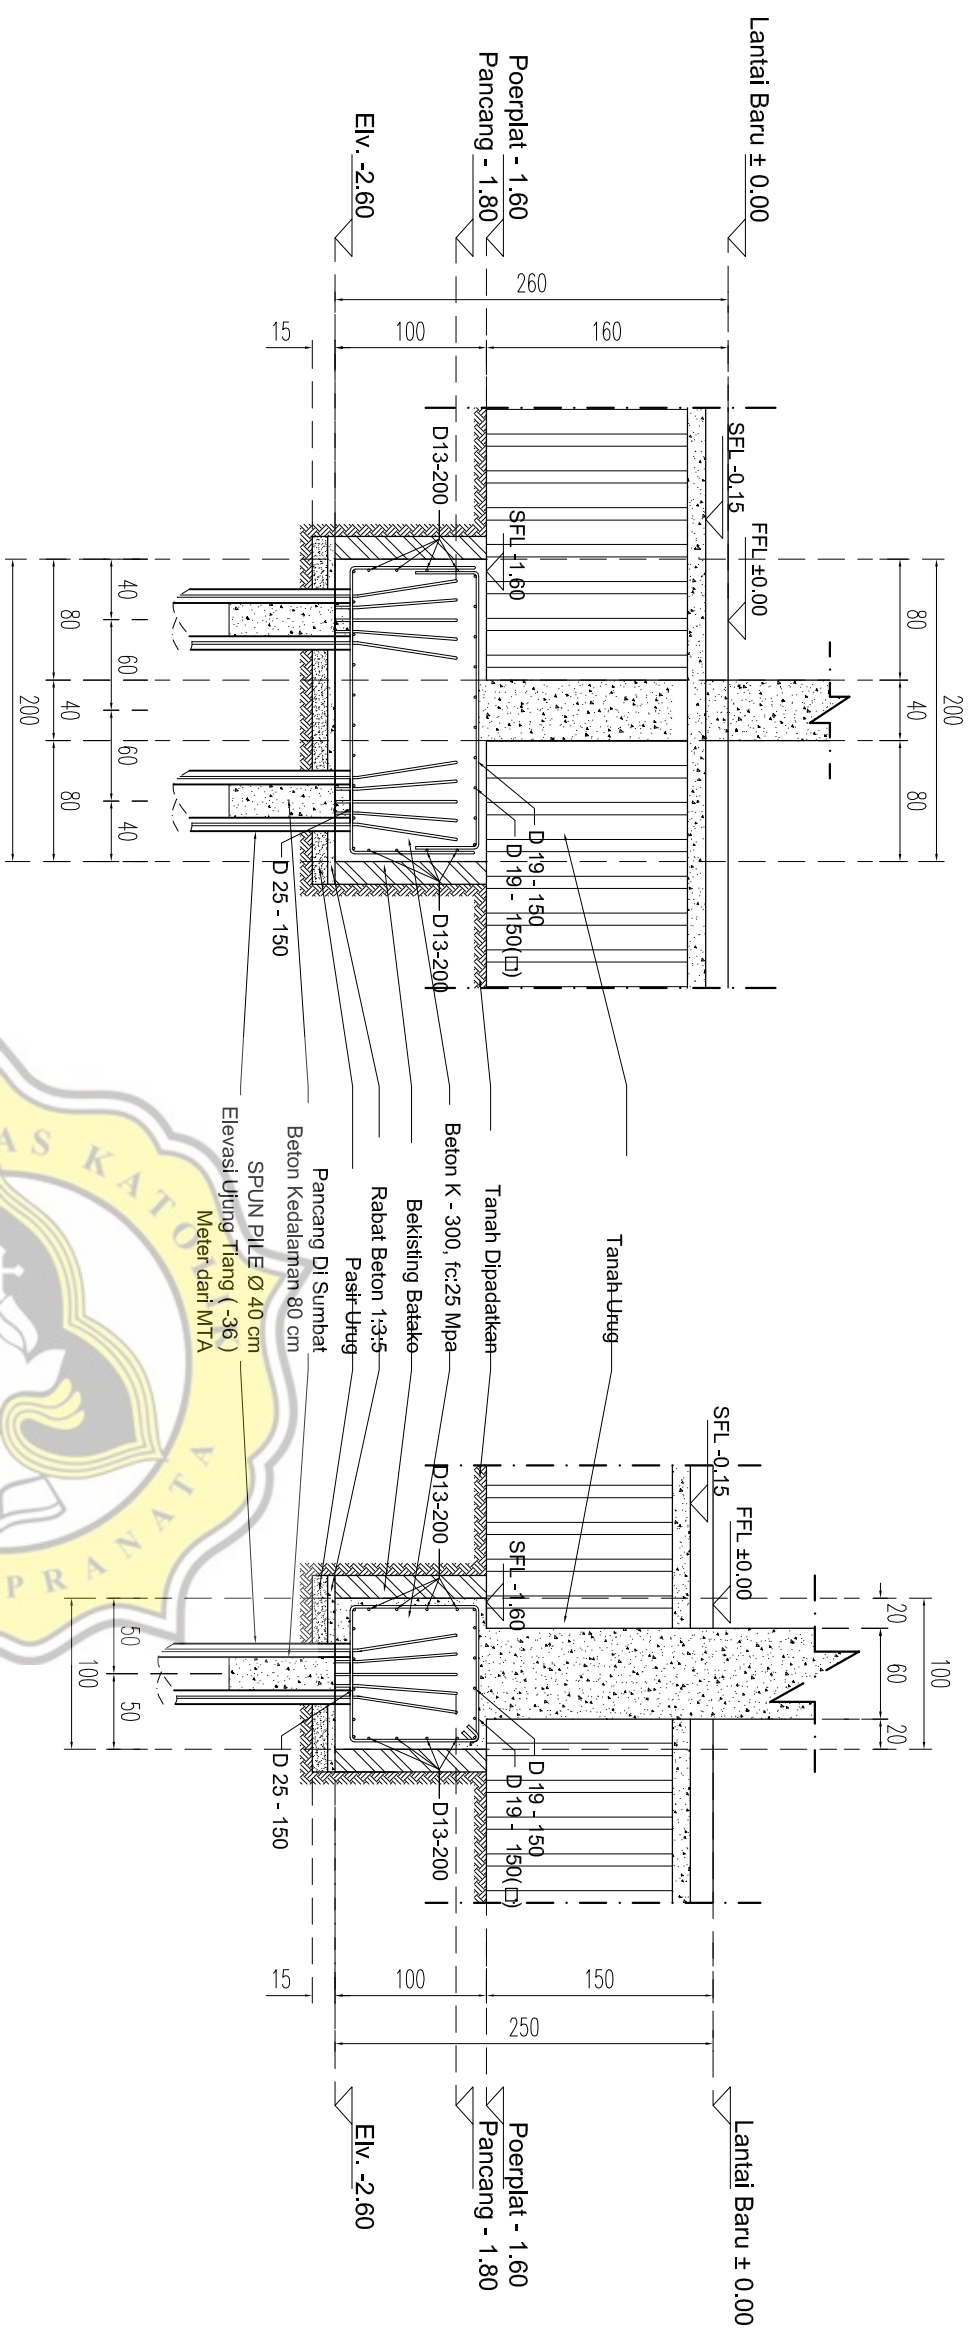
DETAIL SUMBAT SPUN PILE Ø 40 cm
